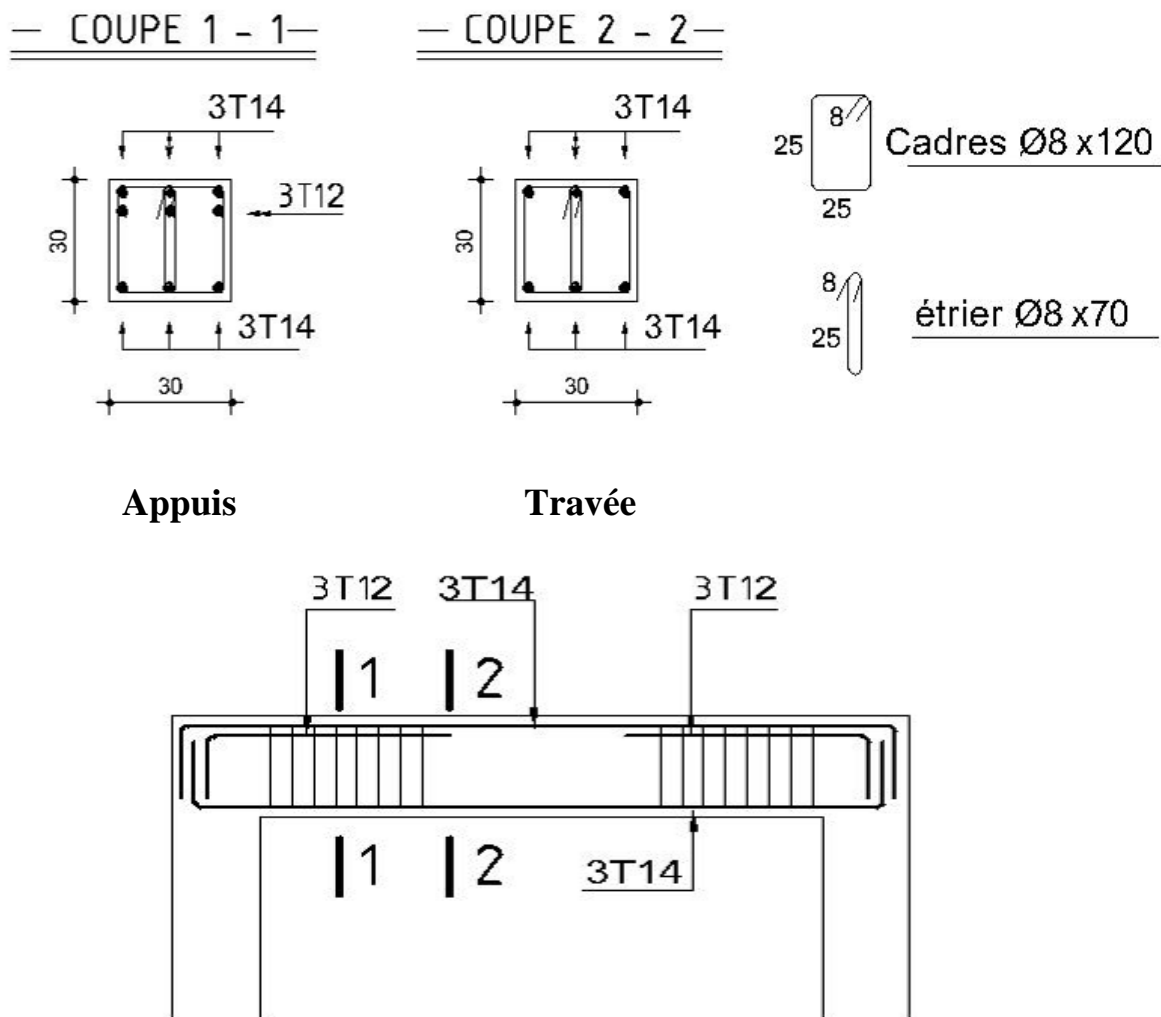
Schéma de ferrailage de la poutre palier.
